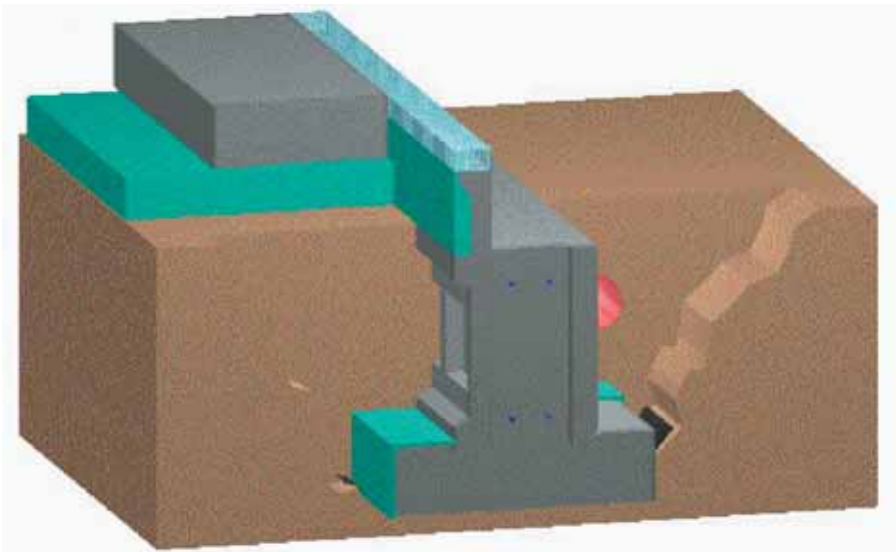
Op de stelblokjes worden twee rechtopstaande prefab-betonplaten eerst globaal geplaatst door een graafmachine. Elke betonplaat wordt daarna exact gepositioneerd, door deze handmatig over de vlakke bovenzijde van het stelelement te verschuiven. Elke plaat heeft inkassingen op regelmatige afstanden (0,25 m), afgedekt met een dunne plaat. Als een doorvoering moet worden gemaakt, wordt de dunne plaat verwijderd. Op deze wijze kunnen leidingen overal ongehinderd worden doorgevoerd
